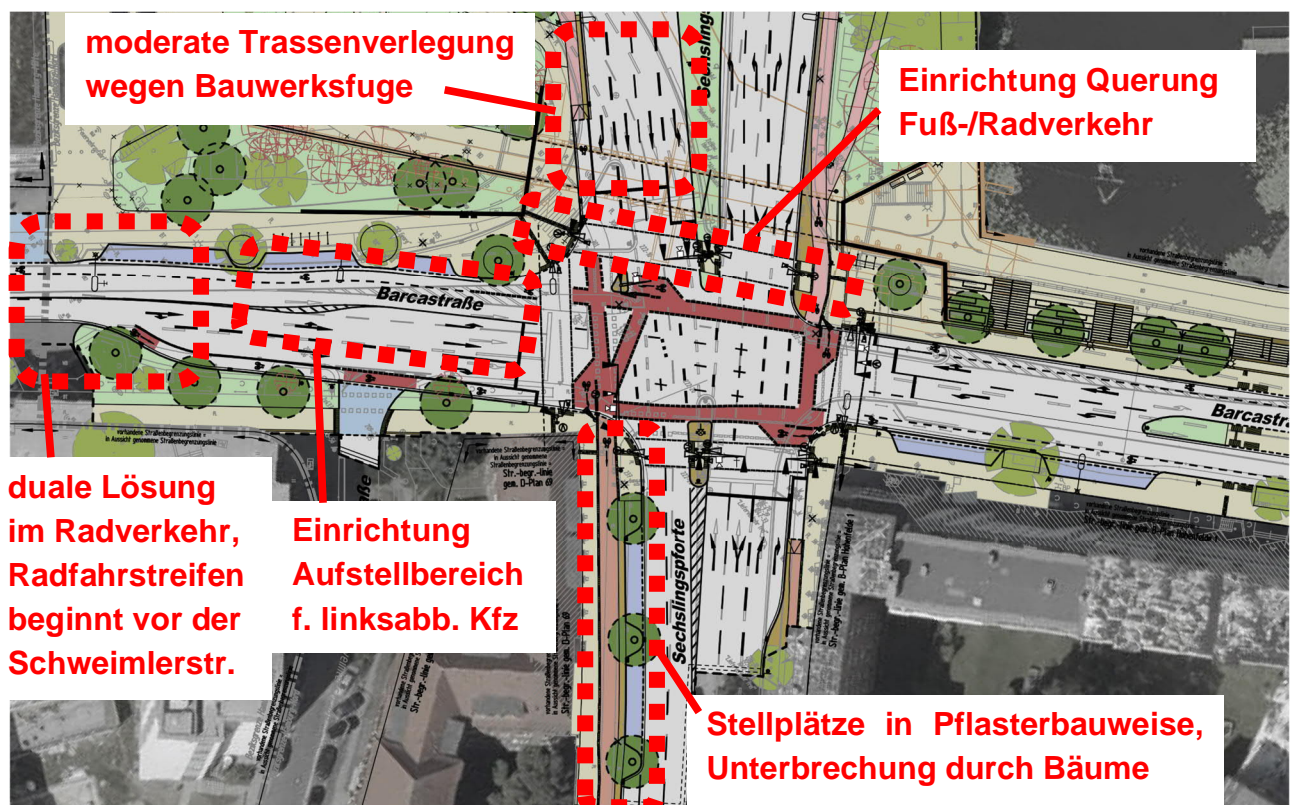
Lageplan-Ausschnitt mit Knotenpunkt Sechslingspforte / Barcastraße
